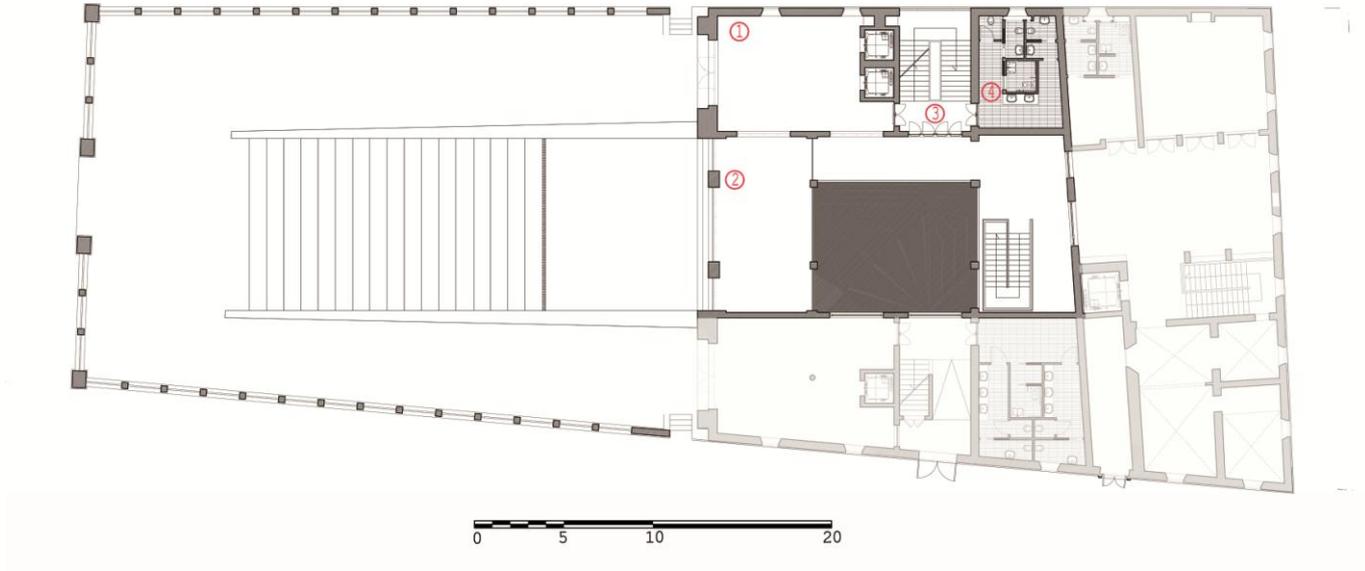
Nuovi Spazi. Piano terra. Progetto
